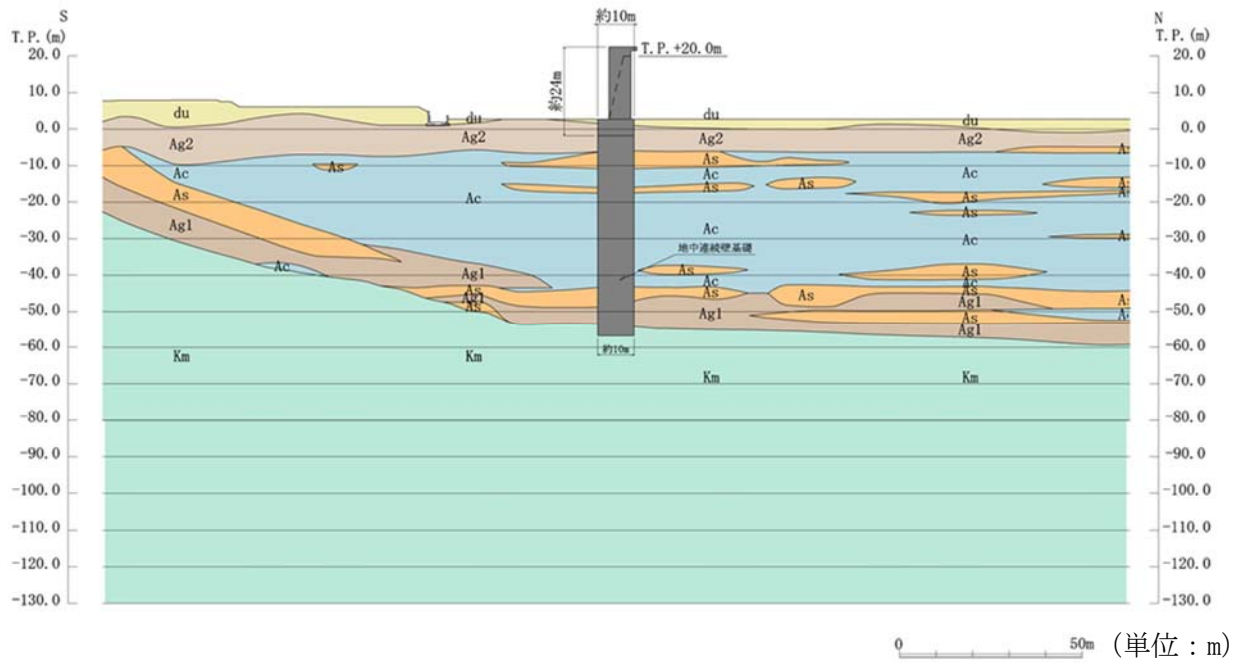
(1) 鉄筋コンクリート防潮壁断面図 (①-①断面)
